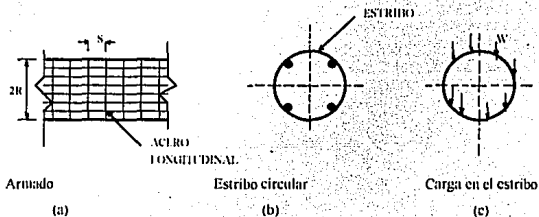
Armado de acero de refuerzo para pilas de cimentación
